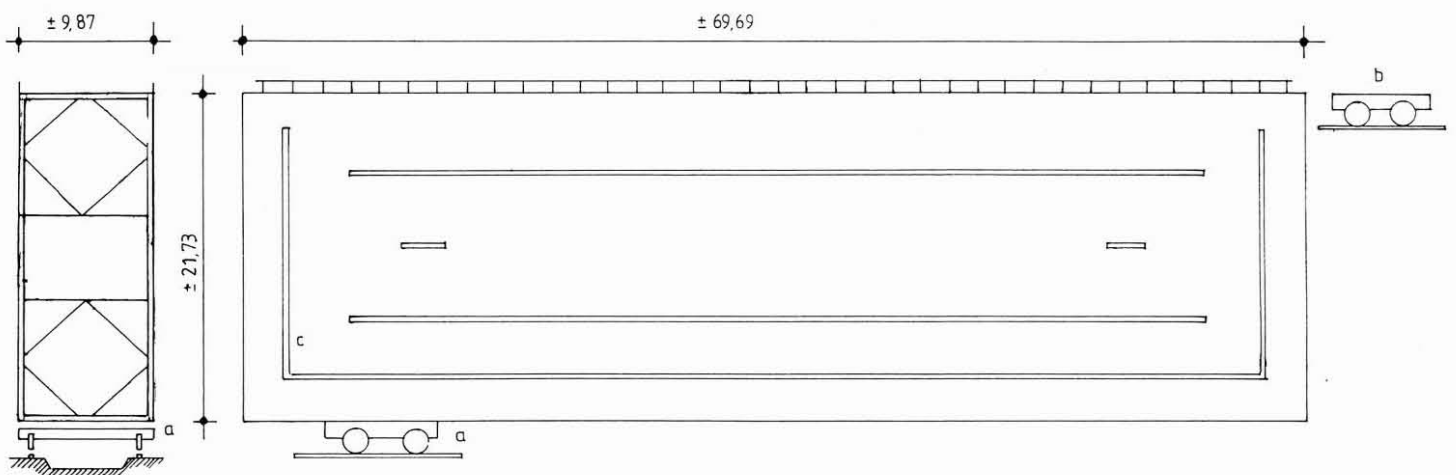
Voor- en zijaanzicht sluisdeuren.
